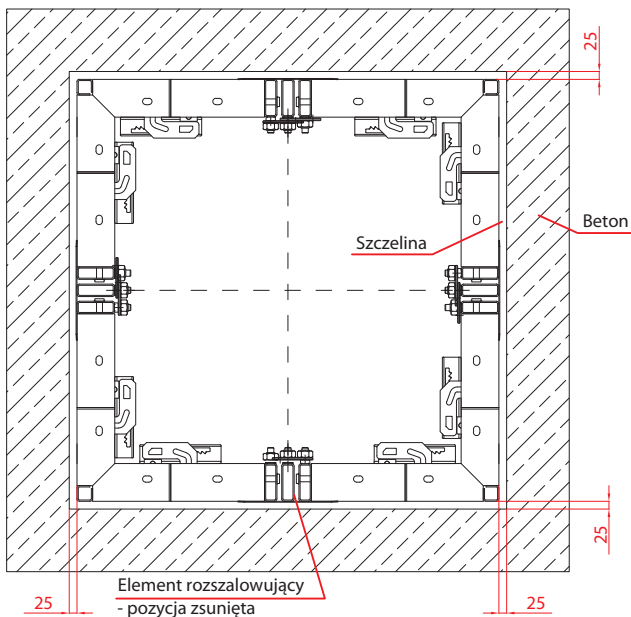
Szalunek zmontowany - beton w szalunku.
